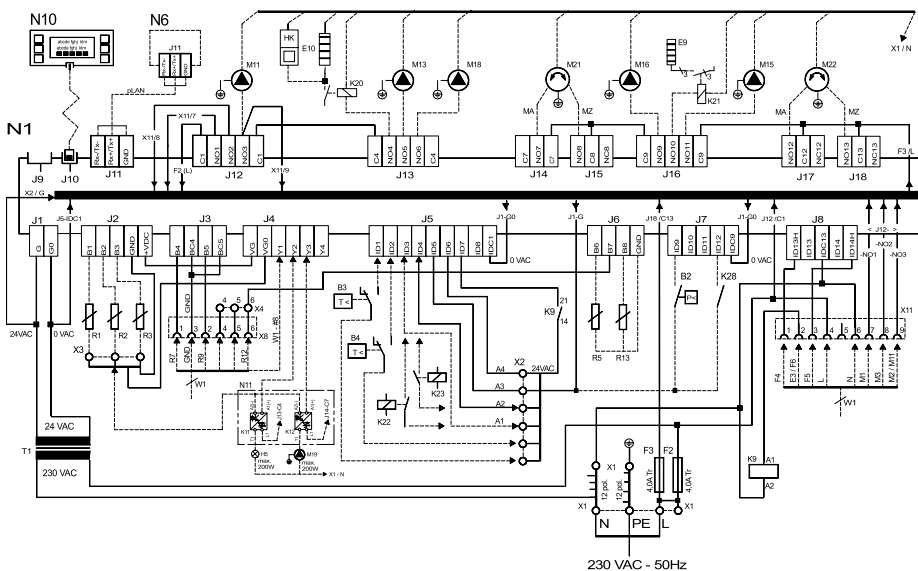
Anschlussplan des wandmontierten Wärmepumpenmanagers
